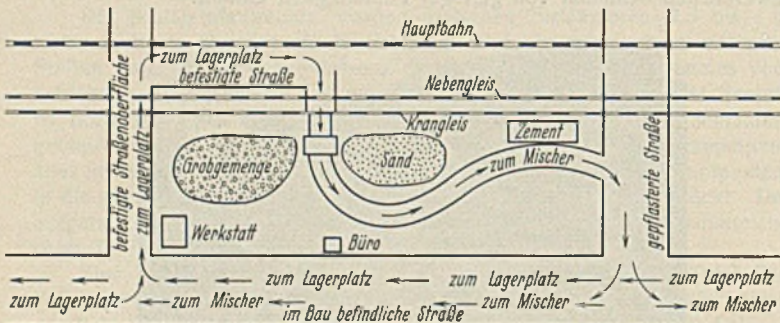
Gutangelegter Baustofflagerplatz für Betonstraßenbauten.
